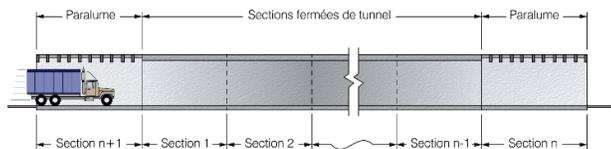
Sectionnement d'un tunnel selon l'orientation générale de la route
